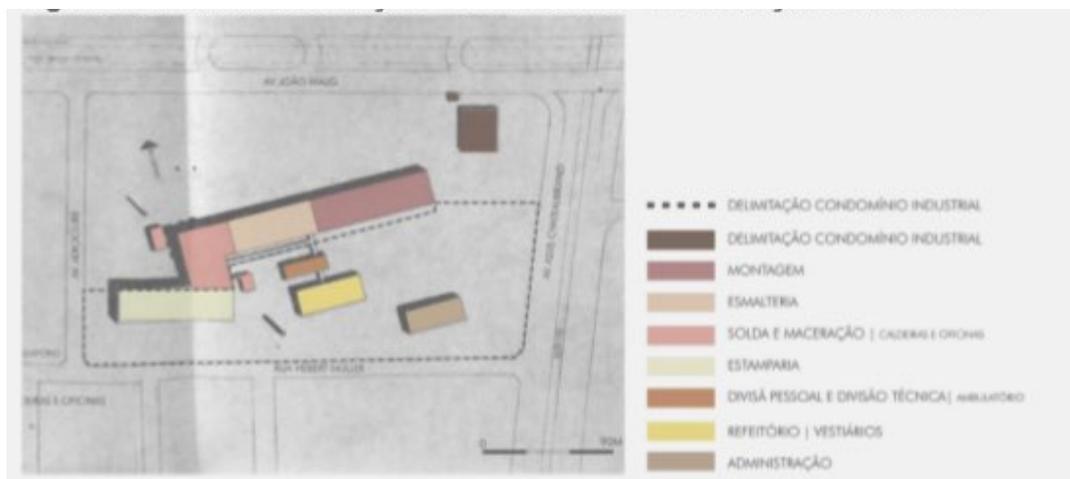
Planta de situação, zoneamento e delimitação do condomínio. Fonte: SEPLAN, fotografado e editado por Julia Leite (2019).
